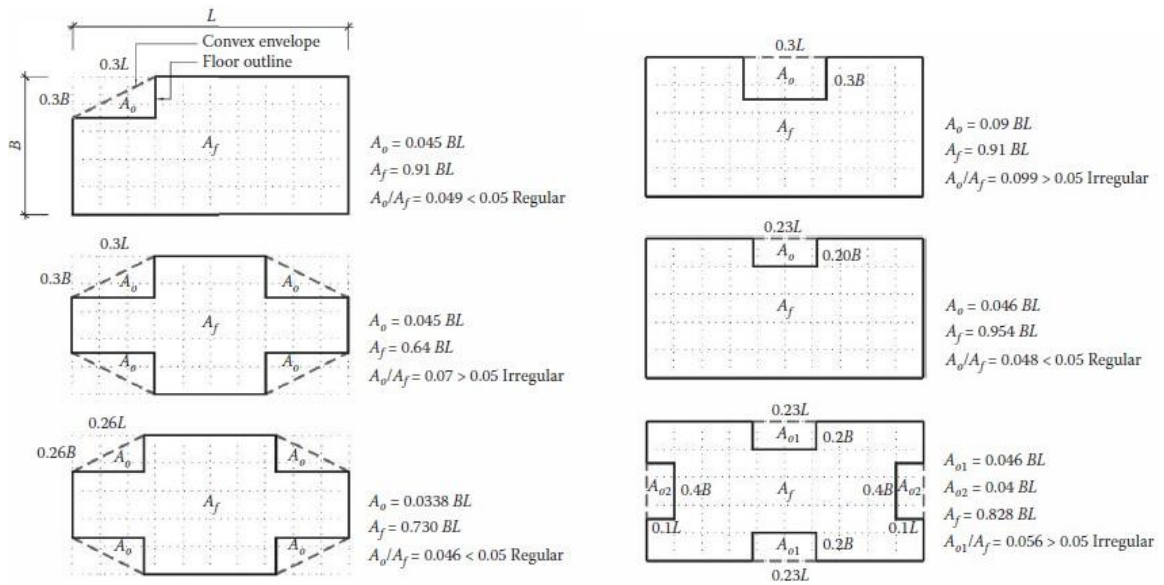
Konfiguracionet e rregullta dhe të parregullta të planit
